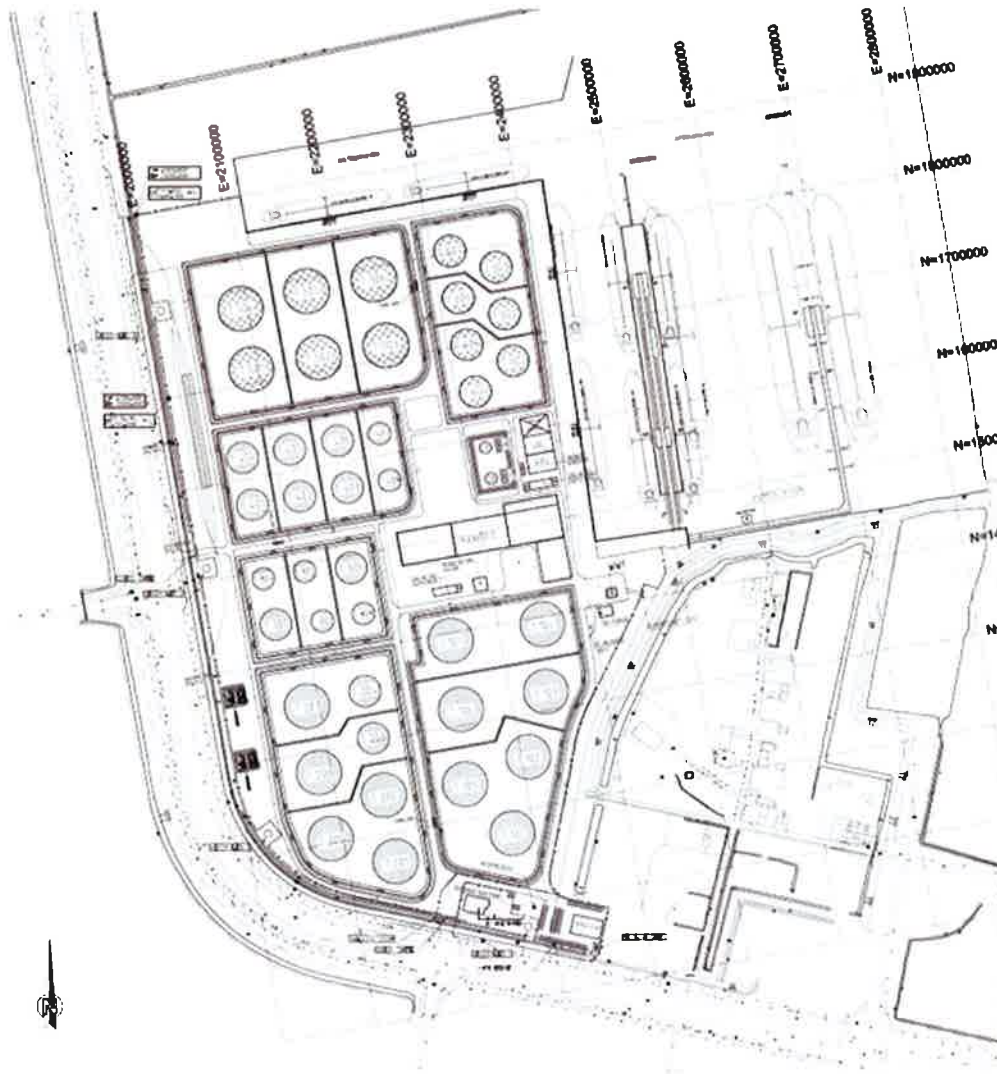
Overzichtplan geplande installaties Vopak Westpoort Terminal
